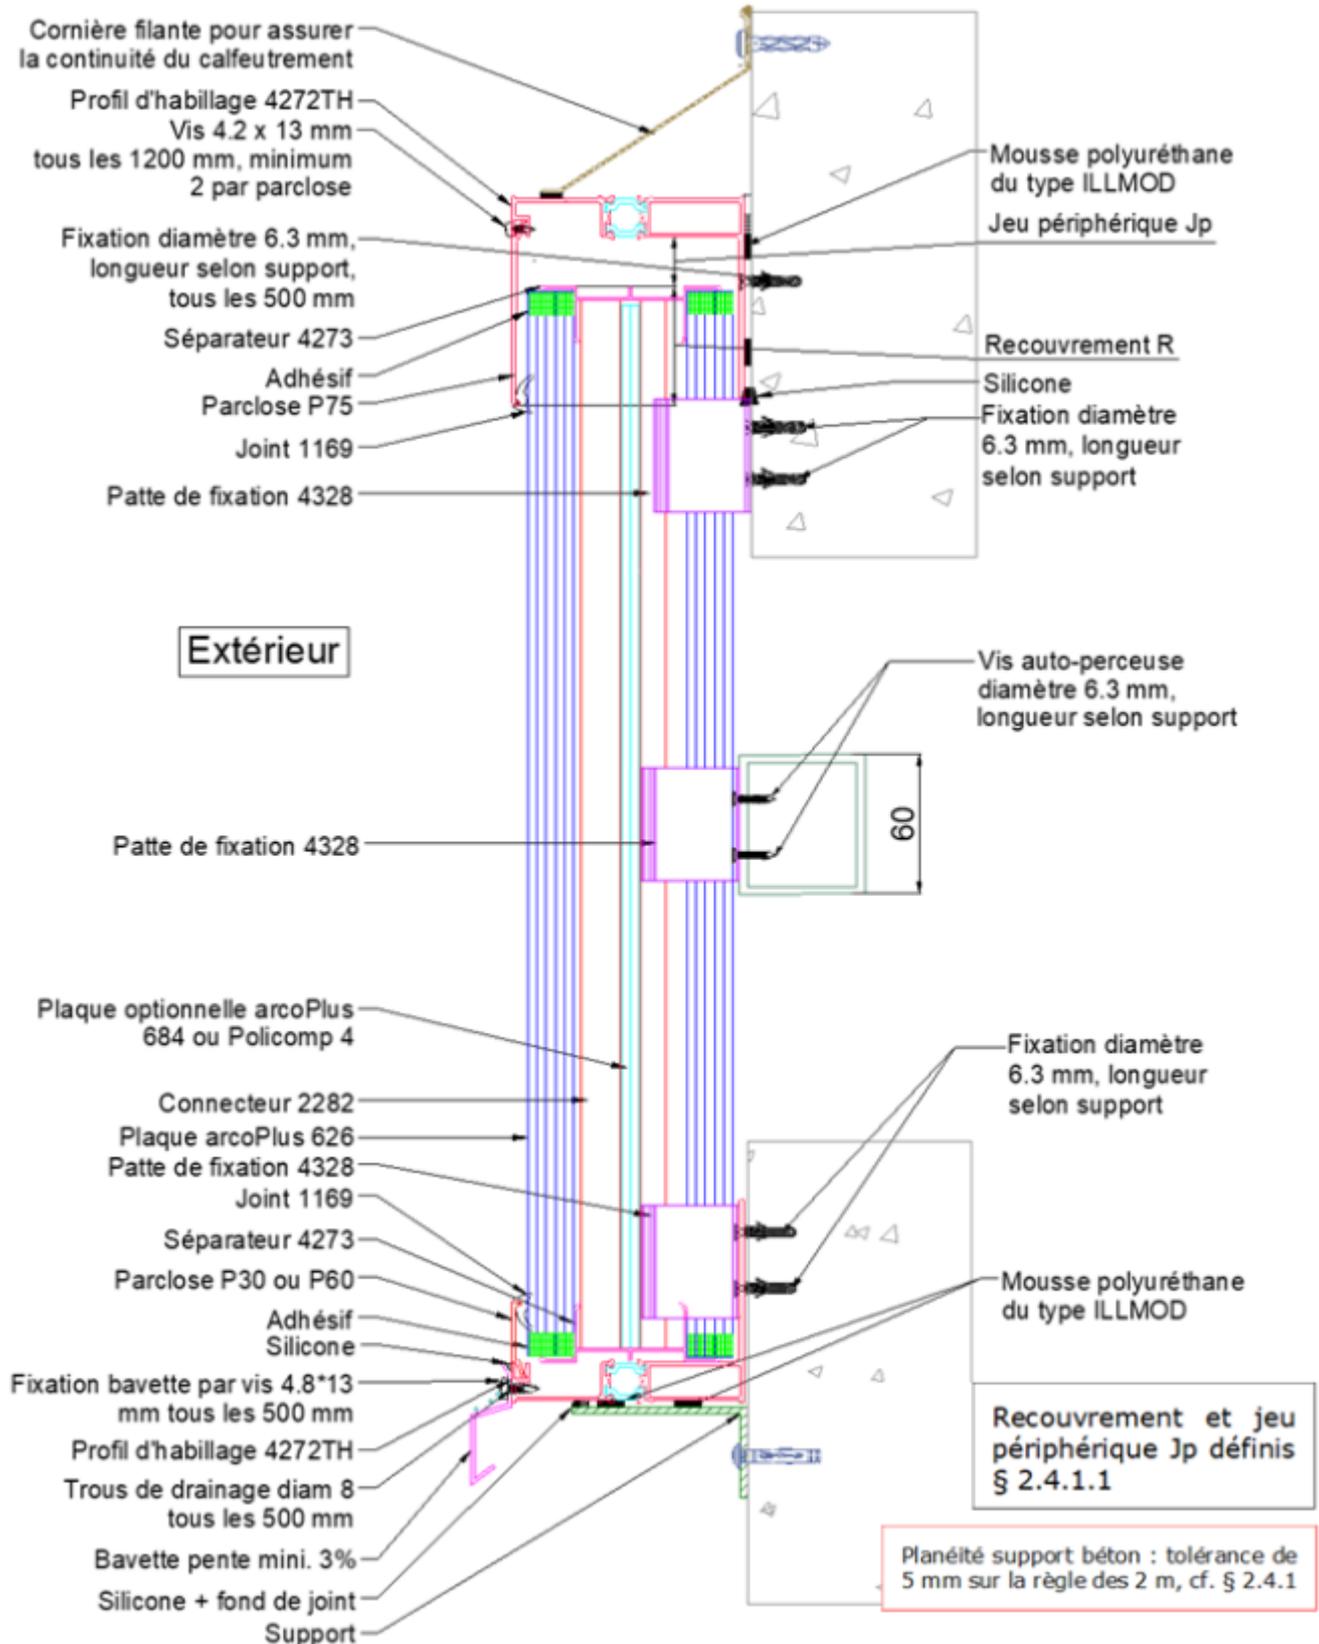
Pose en applique - Hauteur de façade comprises entre 0 et 6 mètres
